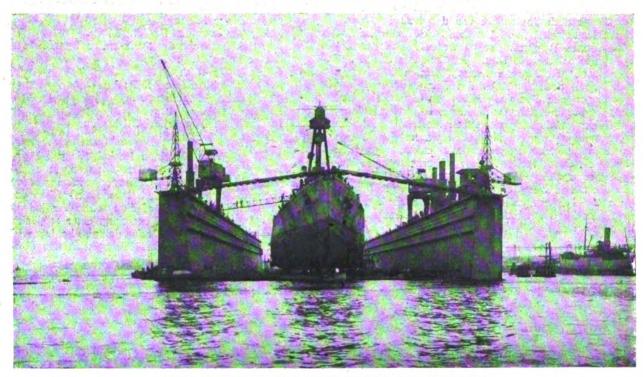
Stirnansicht des Docks mit dem Großen Kreuzer "Hindenburg"
